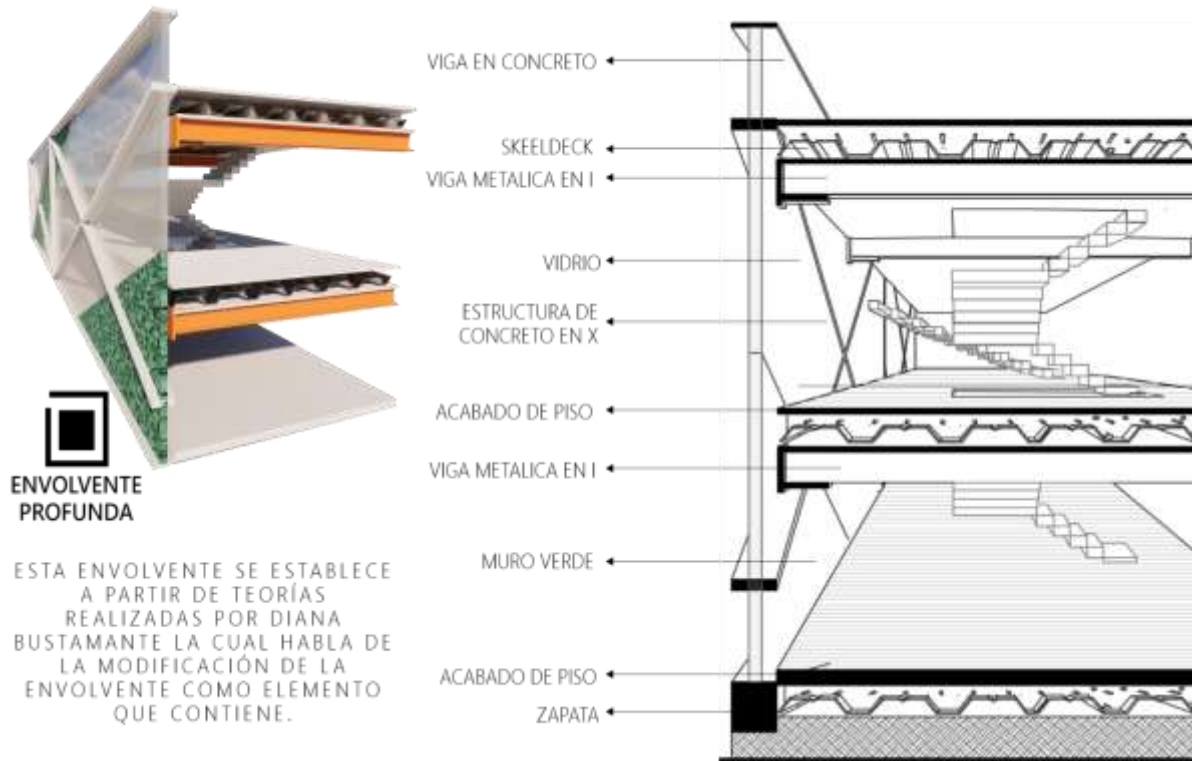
Corte. (Corte fachada envolvente 2). Autoría propia.
